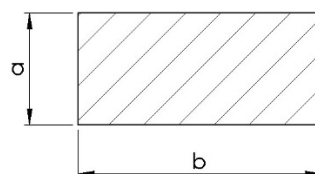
Sección rectangular maciza de una viga transversal (Fuente: propia)
